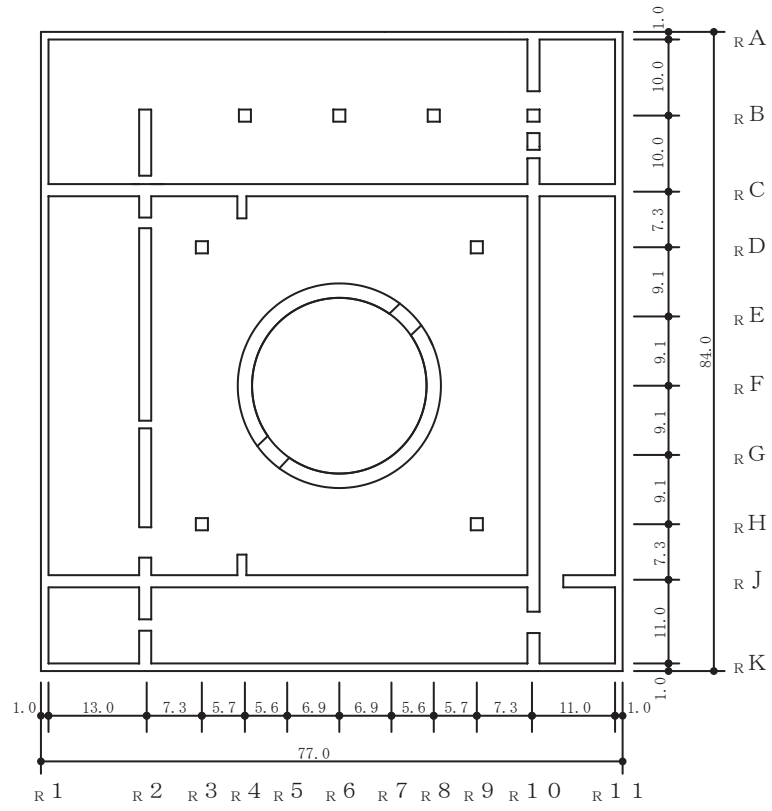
(1) 原子炉建屋の概略平面図 (0.P. -8.1m)
